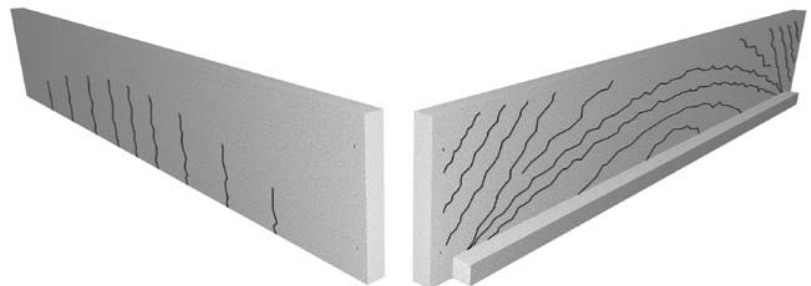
Fissuração observada em ensaios realizados por Klein (1986) [LOGAN, 2007].
